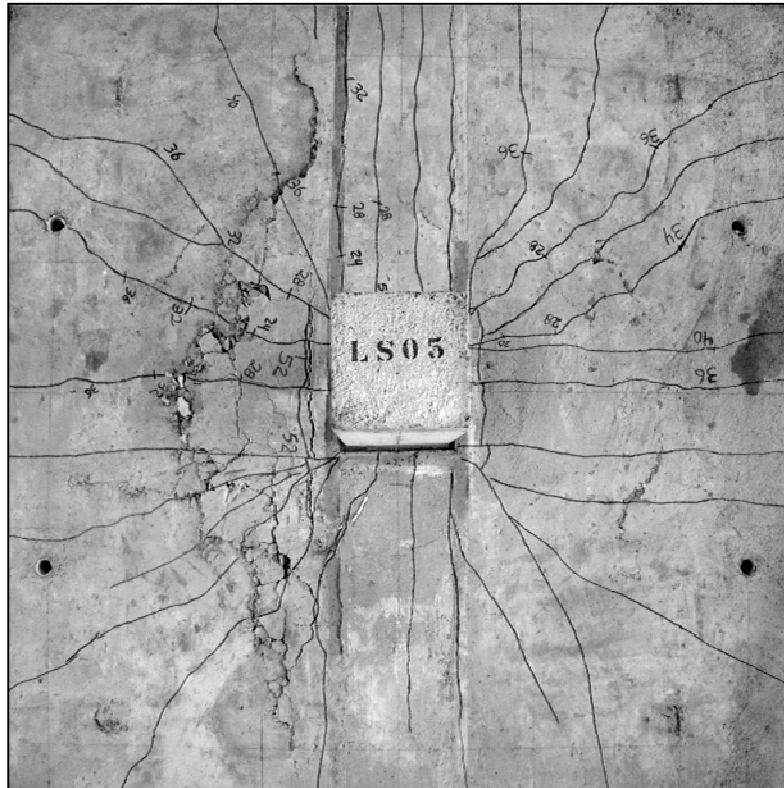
Mapa de fissuração da laje LS05
